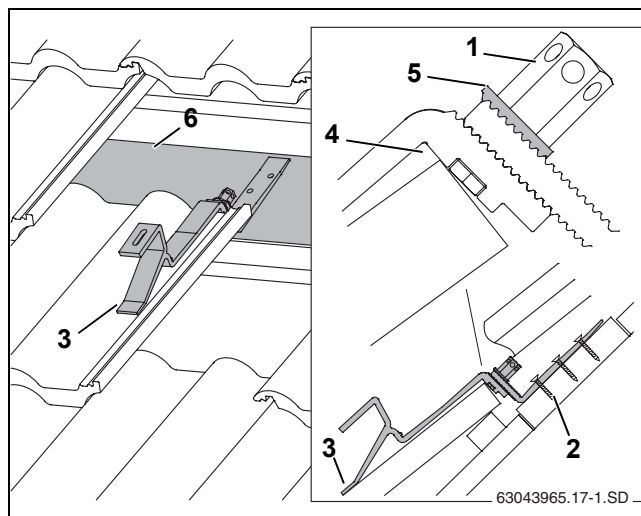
Gancho de tejado montado (para facilitar la vista se han eliminado de la figura algunas tejas)
